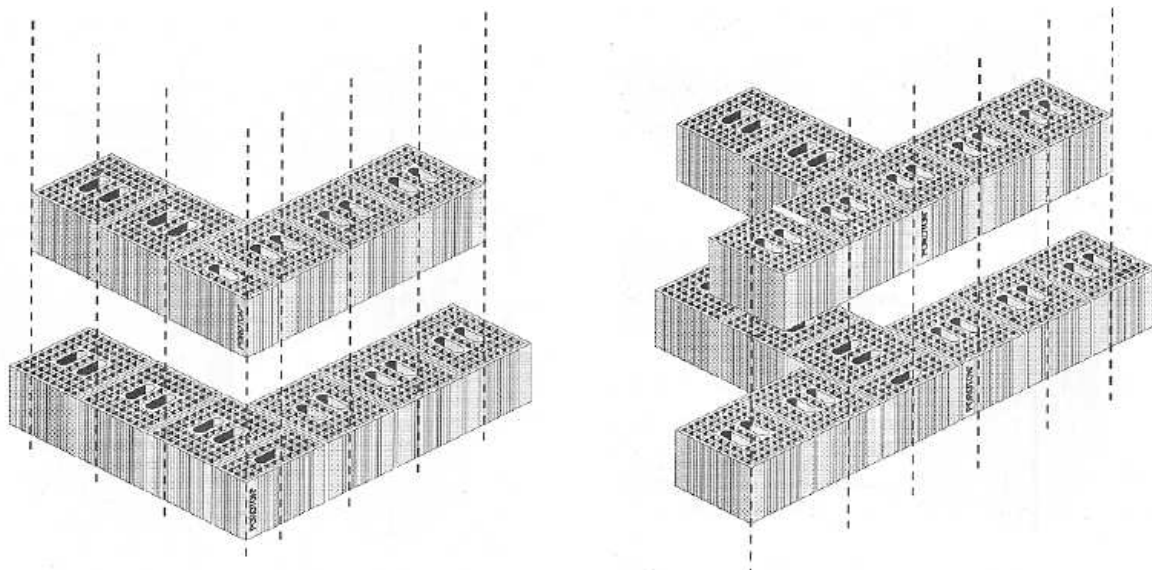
Sovrapposizione degli elementi per muratura non armata
